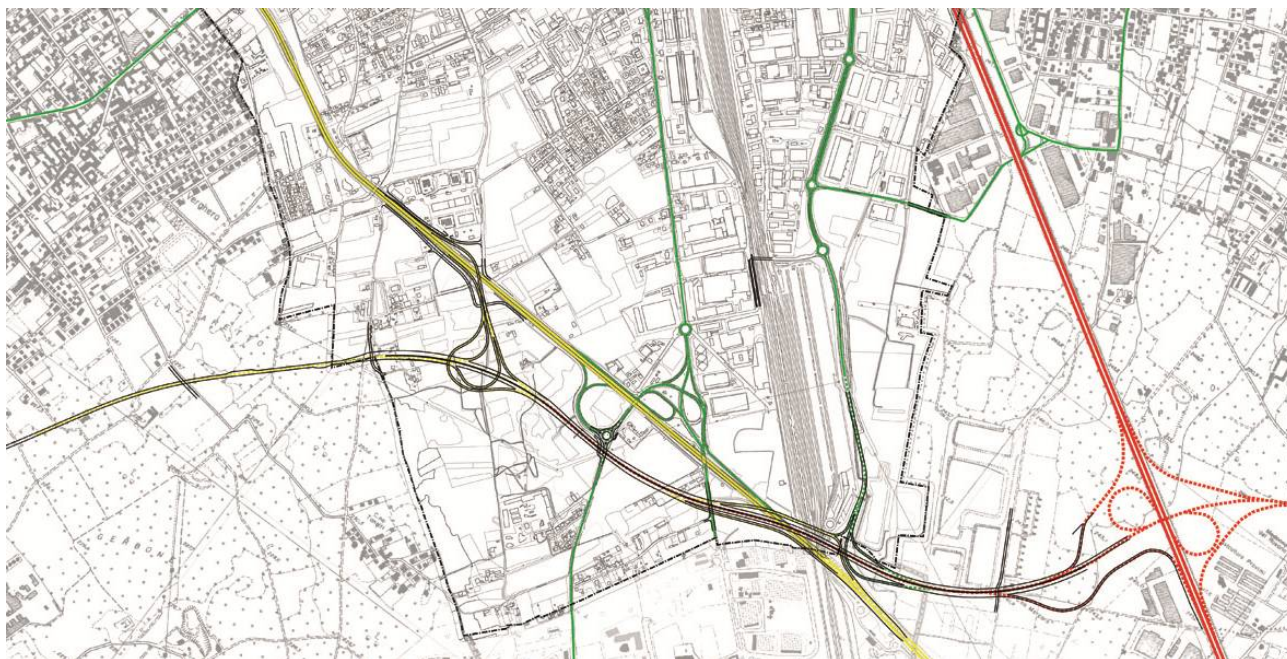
Il collegamento della Pedemontana con la SS 336 e la nuova SS 341
